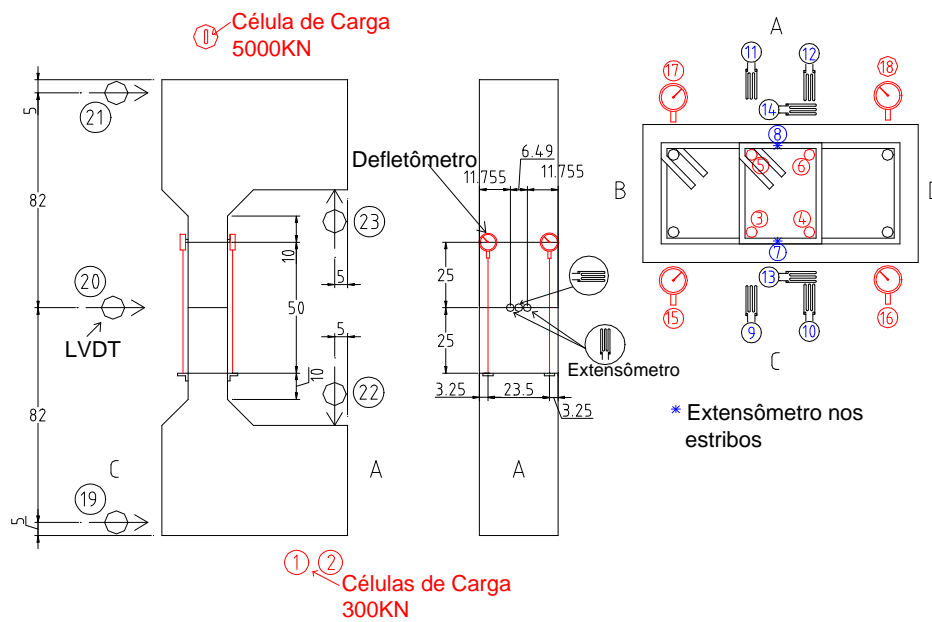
Detalhamento da instrumentação do pilar
